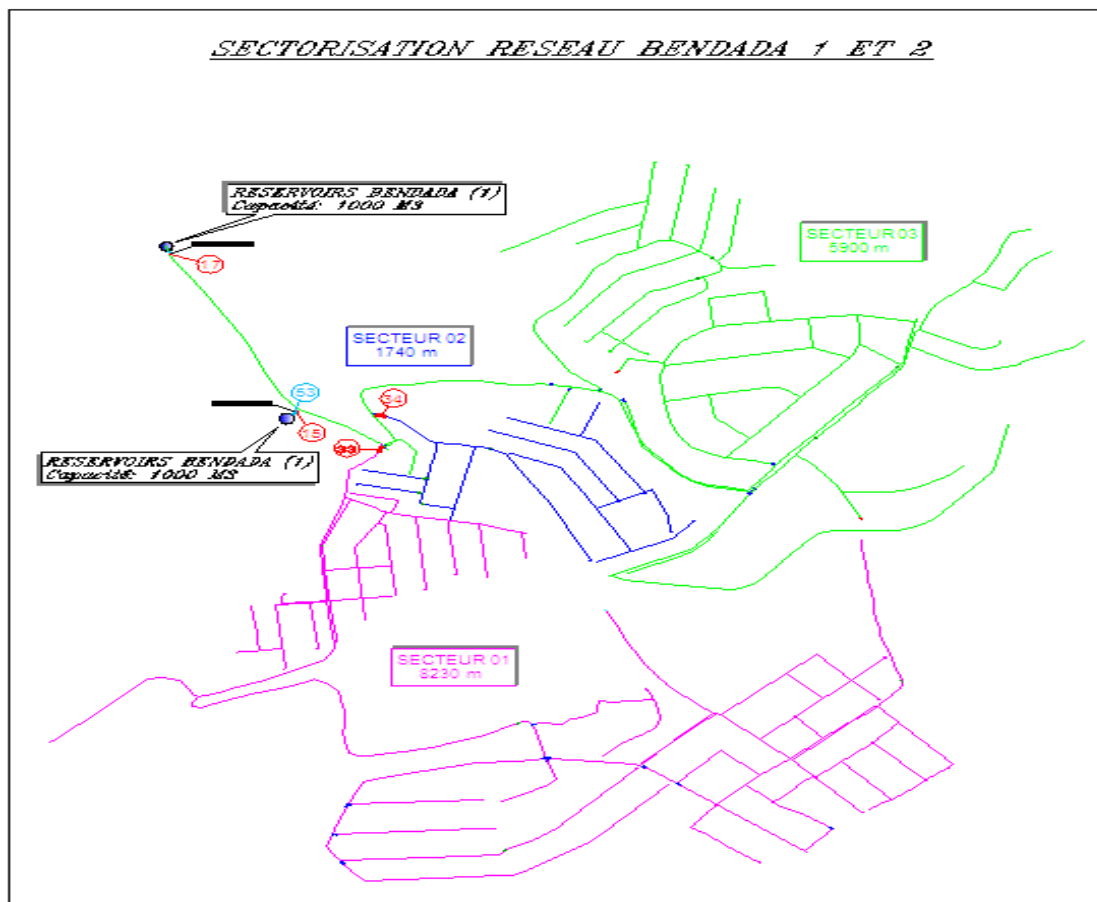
Plan de sectorisation du secteur Bendada 1 et 2
